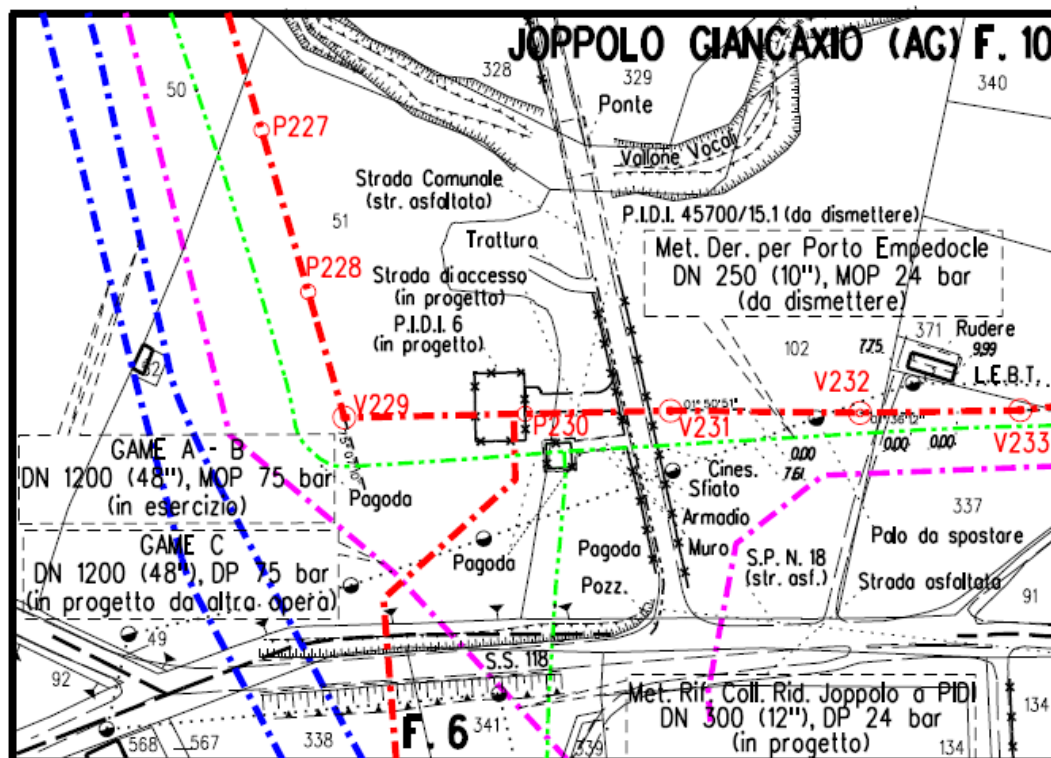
PIDI 6 – Planimetria 1:2000 – Ubicazione area di intervento (Planimetria Catastale F.6-10)
